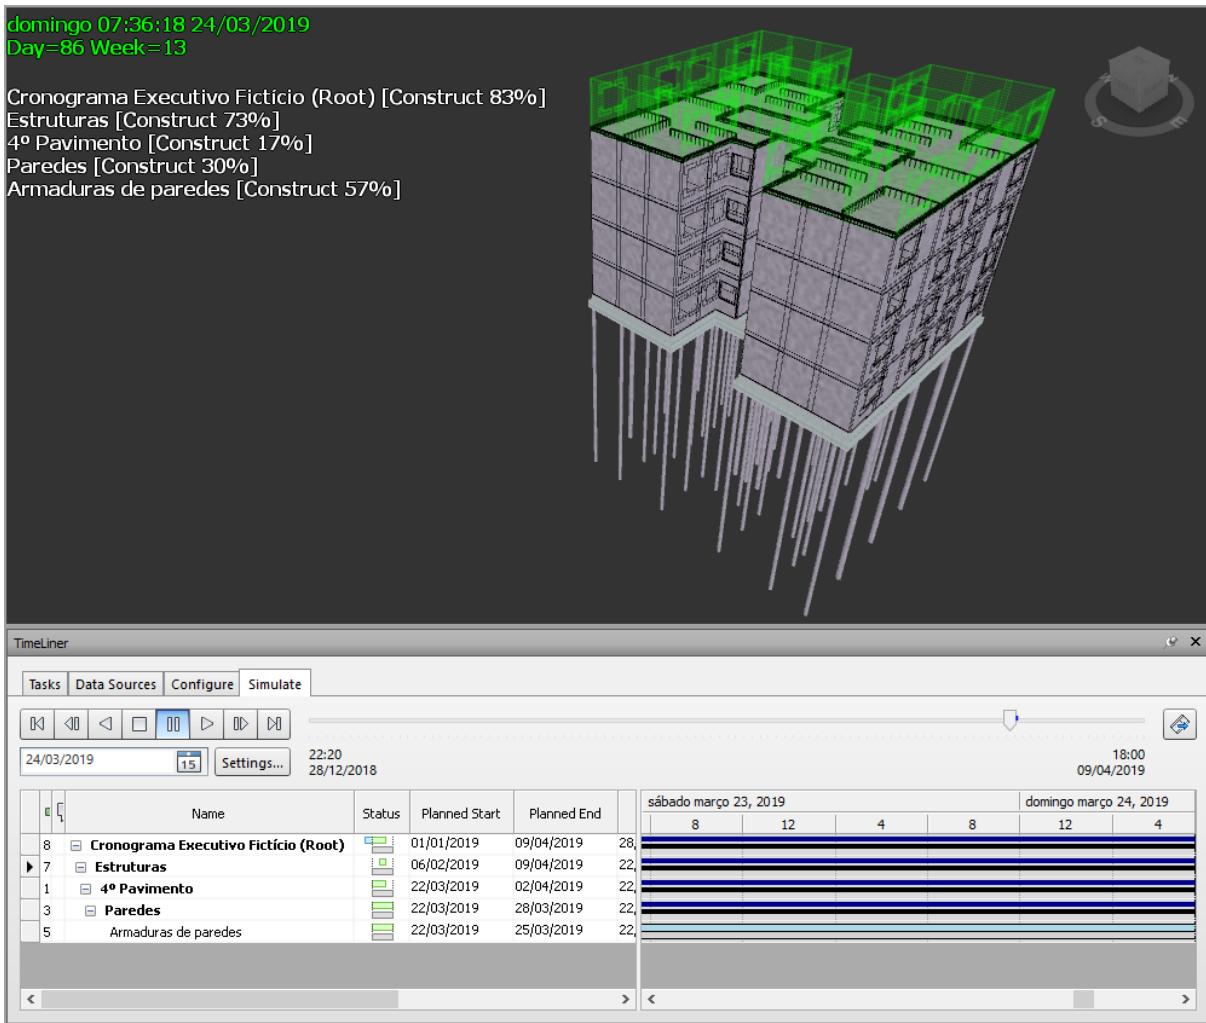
Armações de paredes do 4º pavimento conforme planejado.
